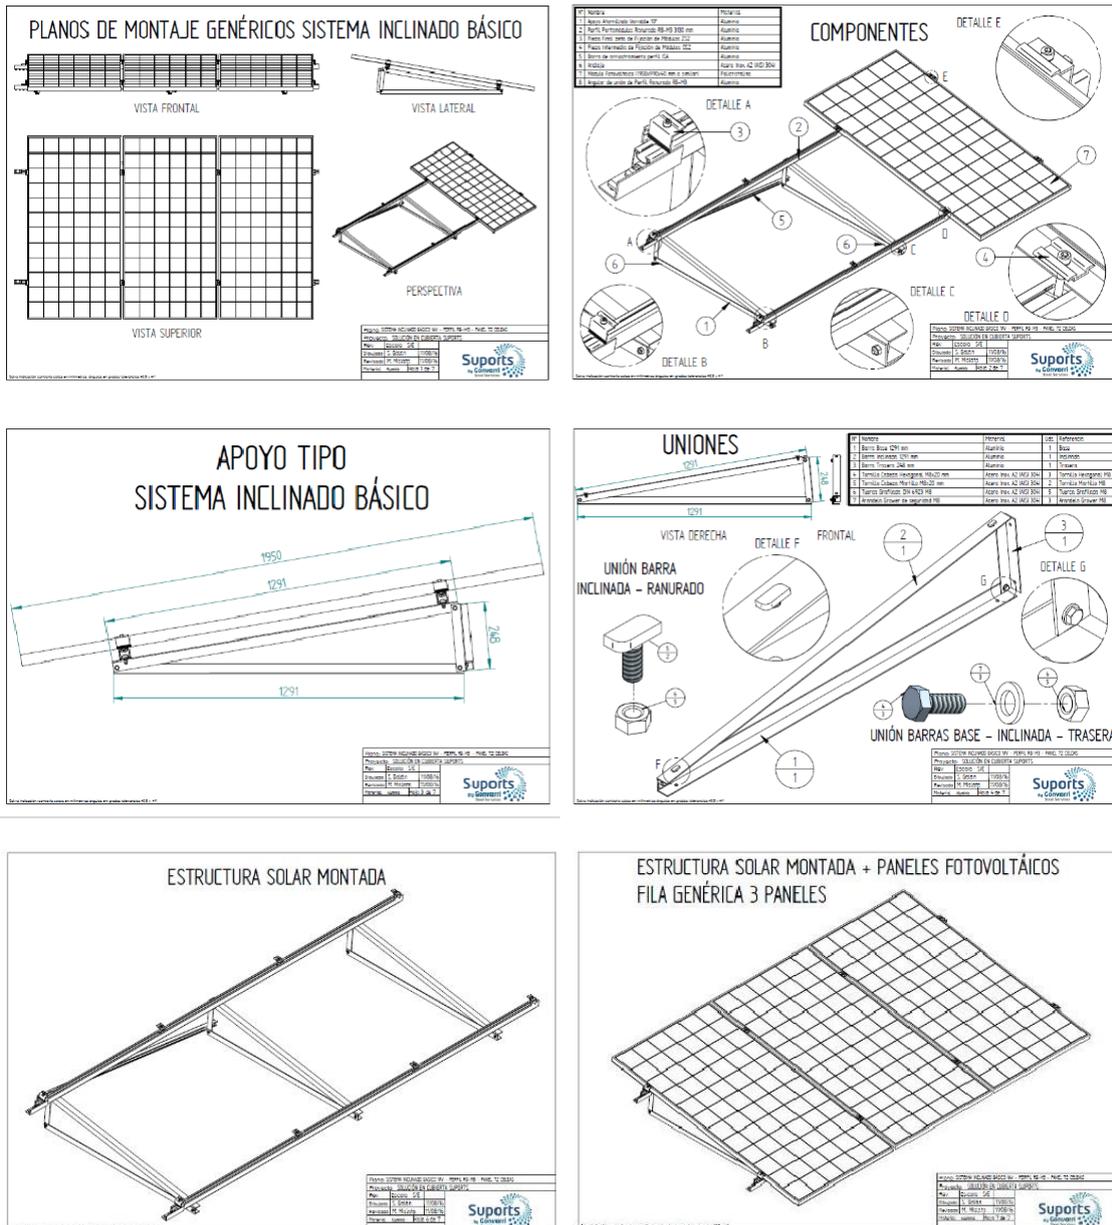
Estructura metálica sobre la que se disponen los paneles solares.
